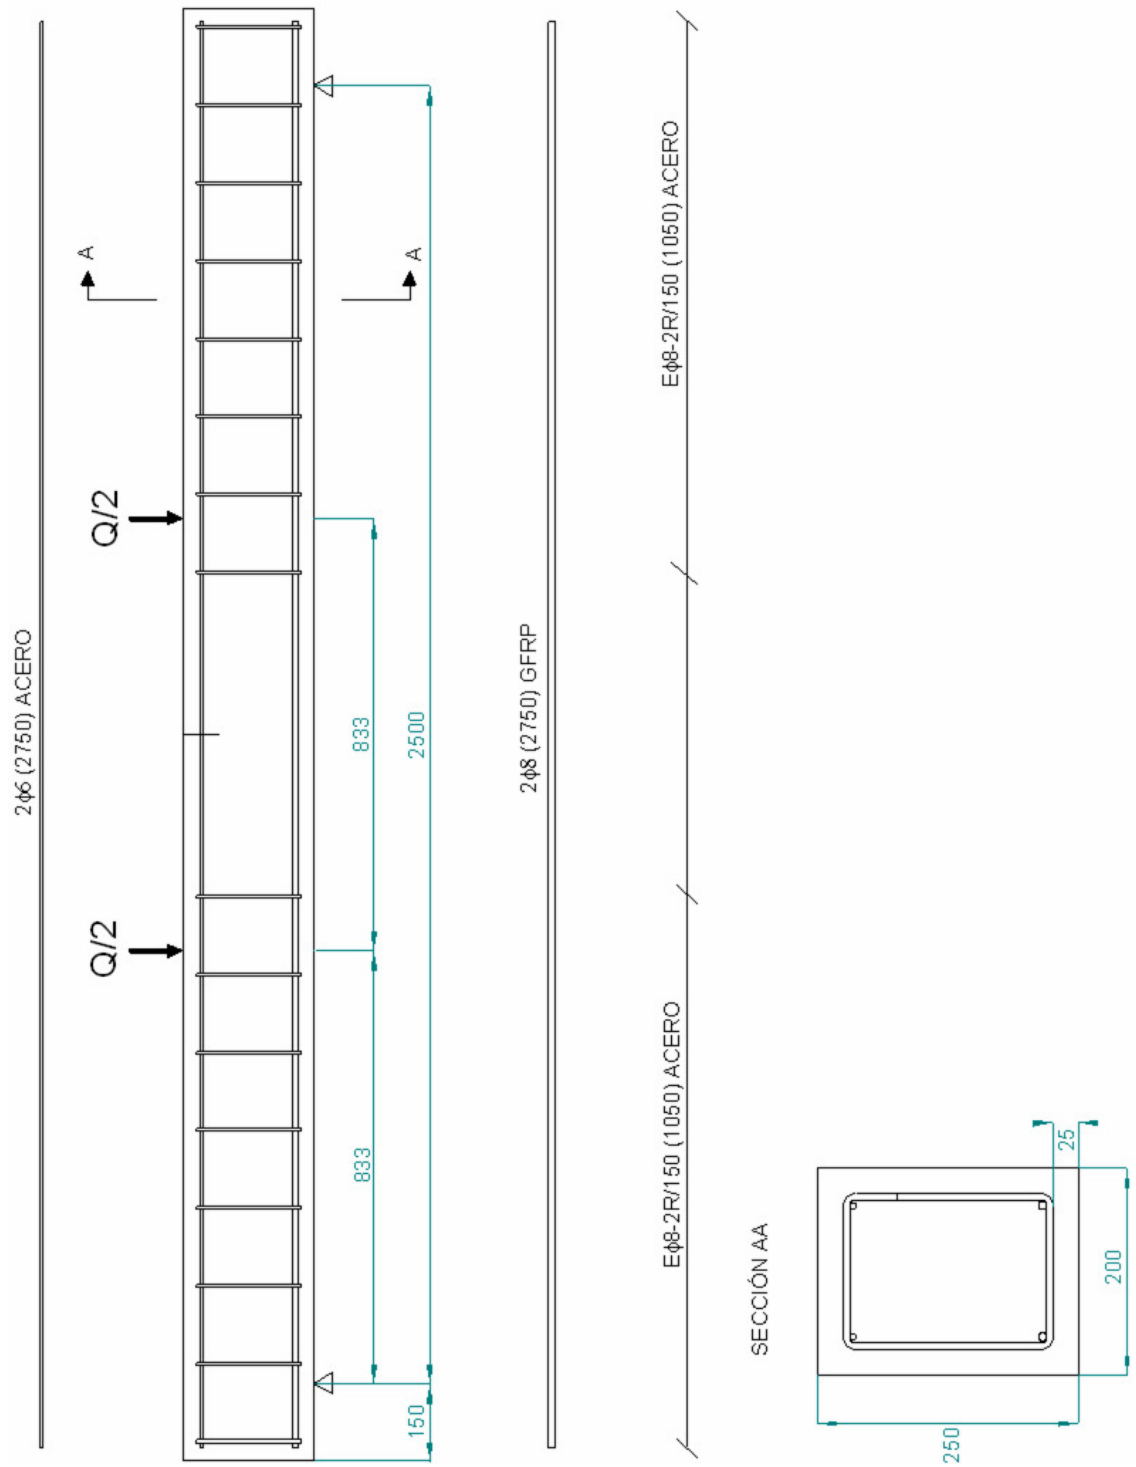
Croquis de la viga por rotura de la armadura inferior a tracción
